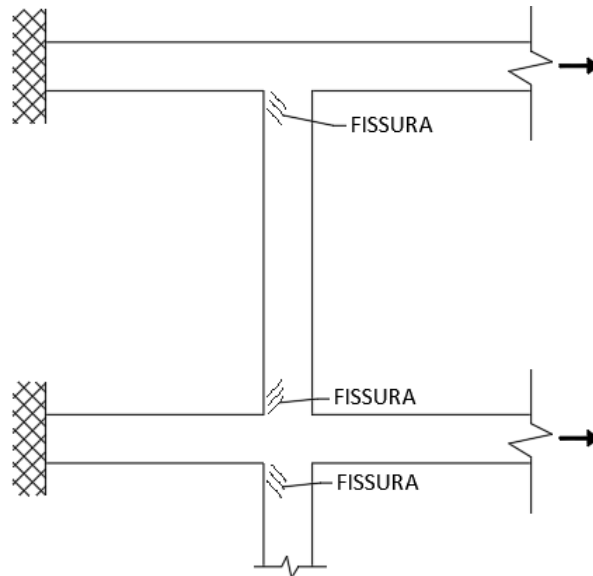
Fissuras formadas em pilares de concreto armado devido à movimentação térmica das vigas de concreto armado. Fonte: adaptada de Thomaz (1989).
